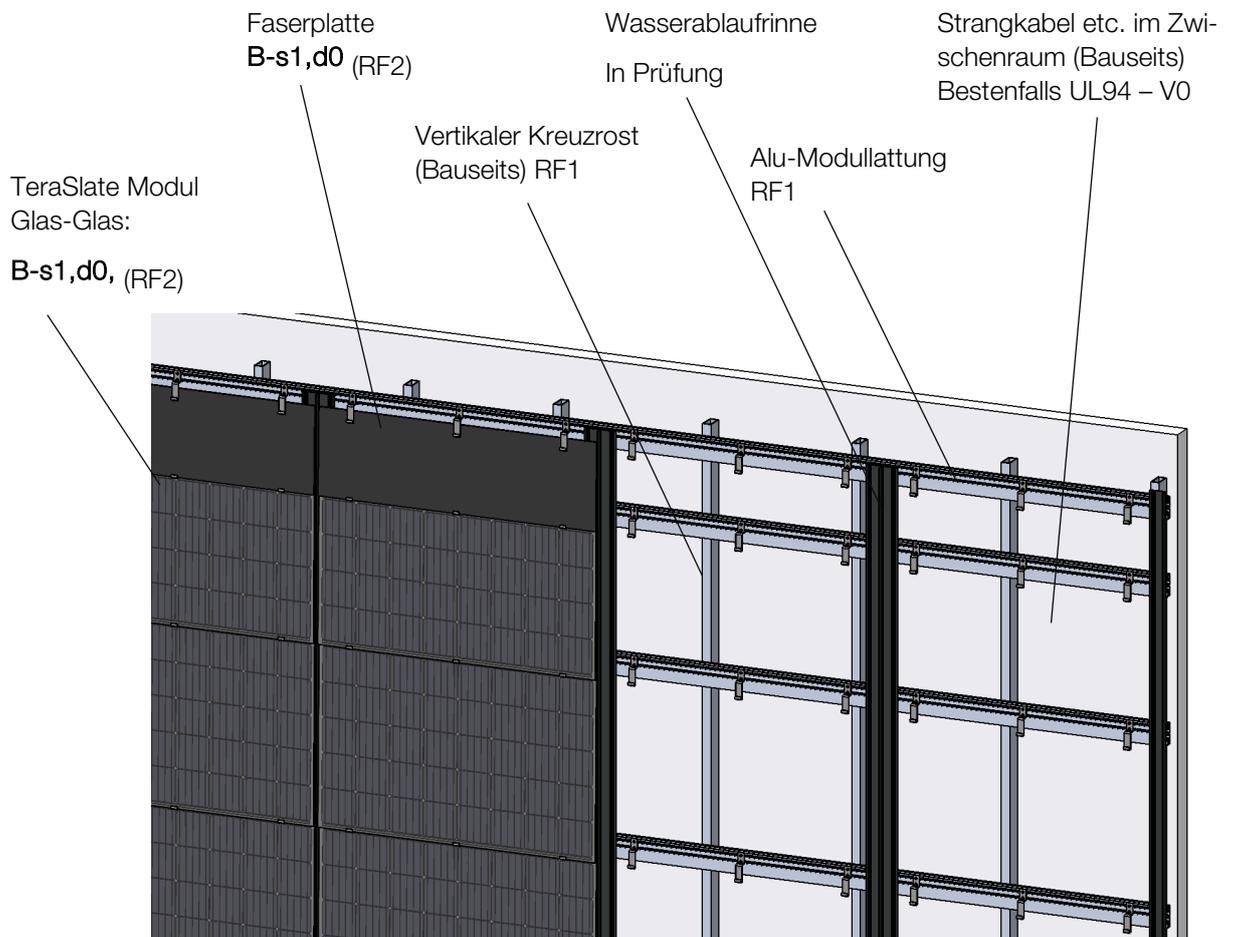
Brandverhalten der Elemente der 3S Solarfassade mit Aluminium-Unterkonstruktion
